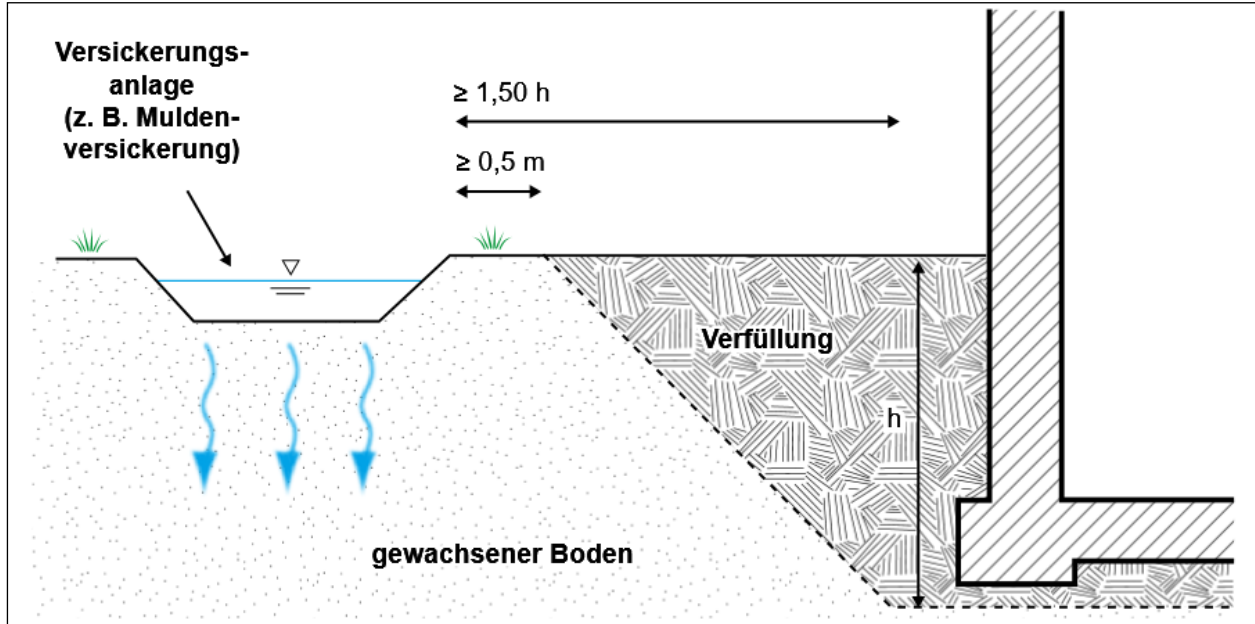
Prinzipskizze Bauwerksabstand dezentraler Versickerungsanlagen [L 21]
